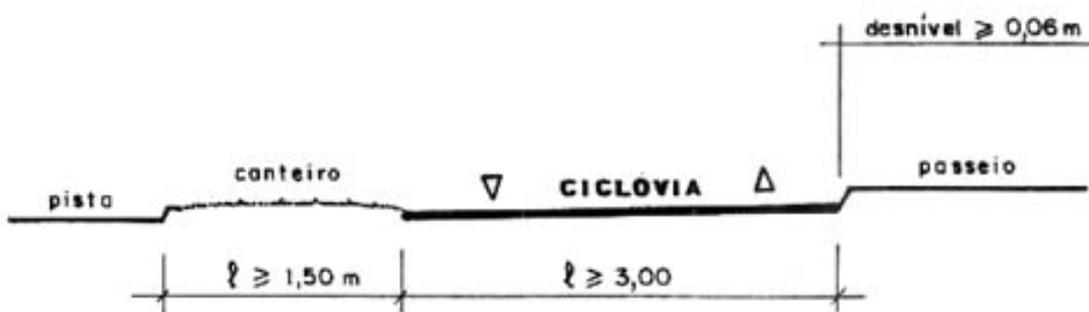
Seção transversal de pista bidirecional junto ao passeio.
